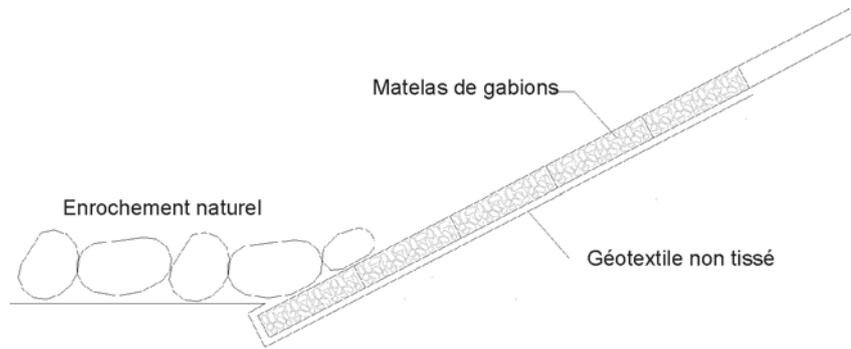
Transition entre un revêtement en gabions et de l'enrochement naturel
